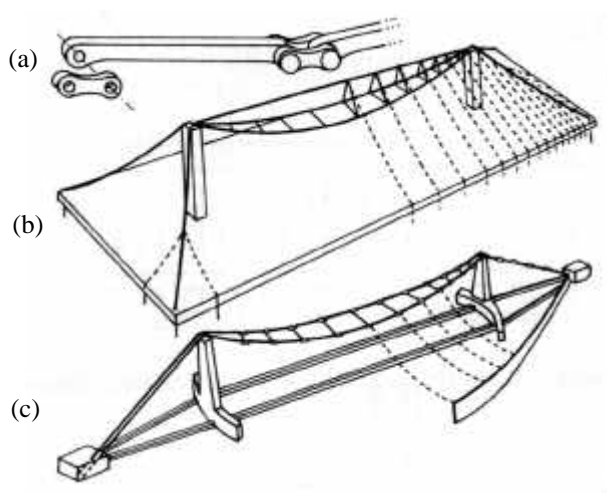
Desenho esquemático (a) de correntes de ligas de ferro empregadas no sistema de suspensão, (b) do esquema estrutural, proposto por B. Schnirch para cobertura de um teatro, (c) do sistema estrutural (com cabos de aço) da cobertura da piscina construída em 1964 em Tóquio por K. Tange e Y. Tsuboi seguindo a mesma idéia de B. Schnirch.
